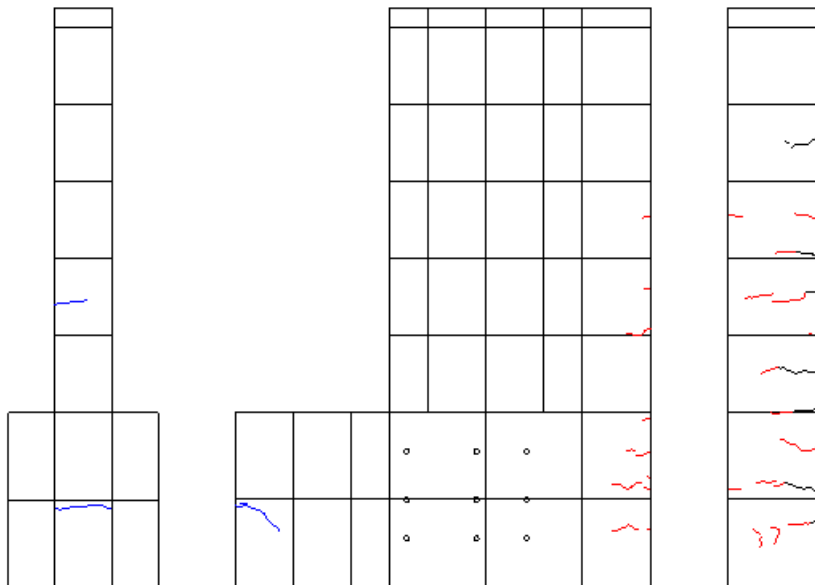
R=-1/800 ひび割れ図
